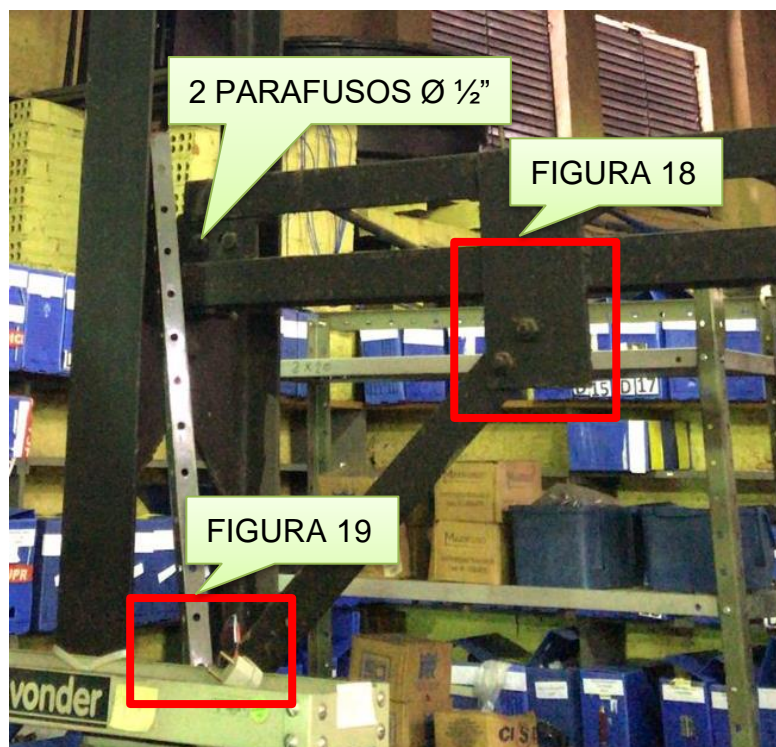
FIXAÇÃO DO TRAVAMENTO
